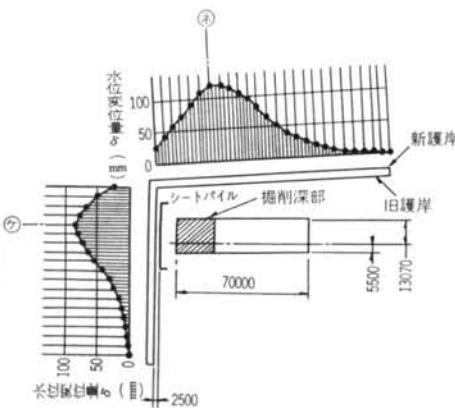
基礎ぐい打設終了時の旧護岸の変位状況
